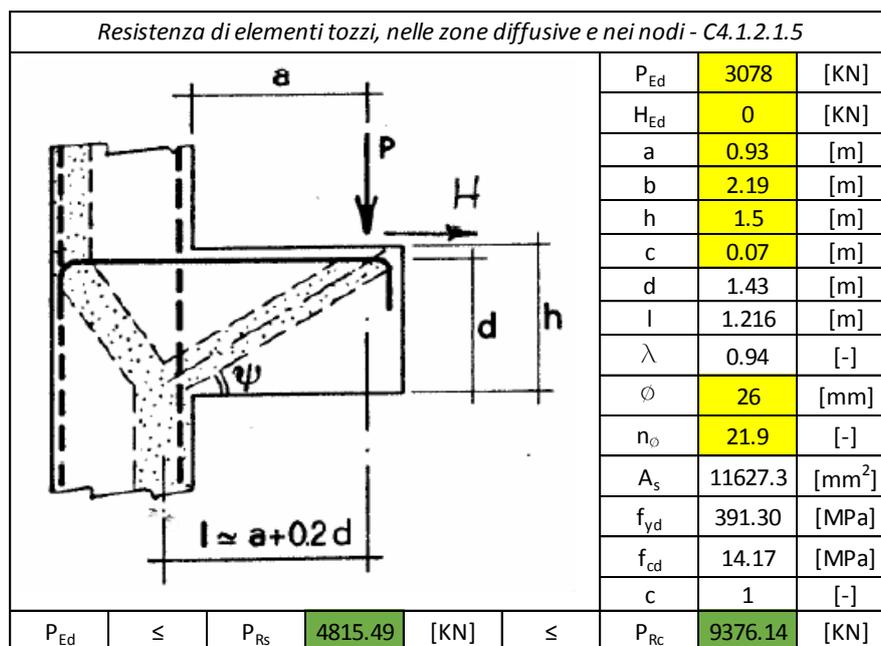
Verifica Tirante Puntone Zattera di fondazione, palo 3
